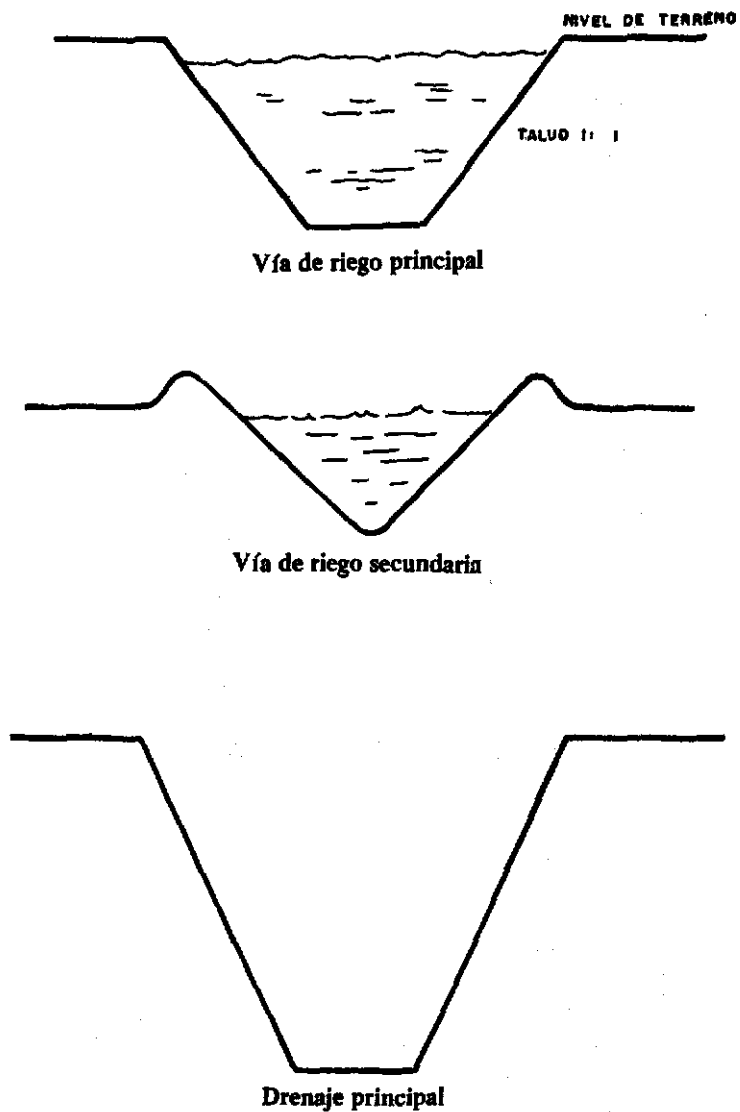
Diseño y construcción de vías de riego y drenajes
